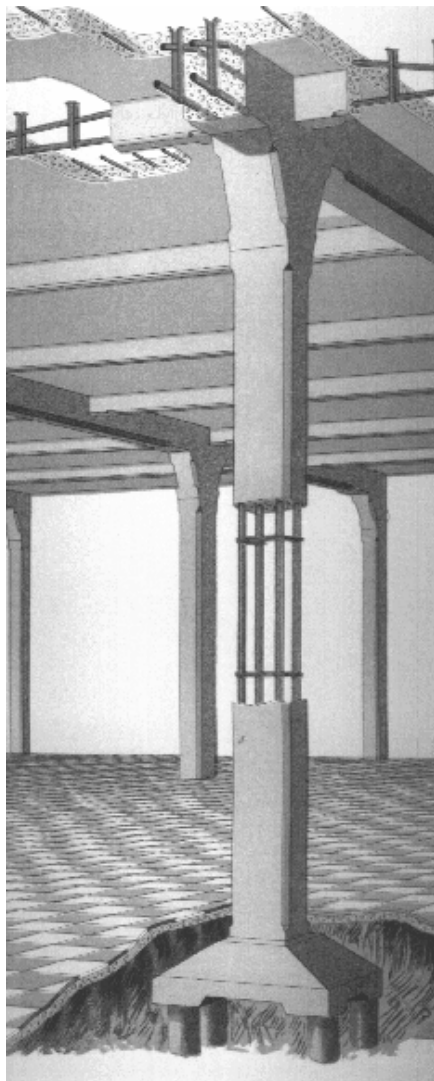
il sistema *Hennebique* permetteva la costruzione completa di un'ossatura portante monolitica in conglomerato cementizio armato che prevedeva plinti di fondazione (o travi rovesce o platee), pilastri, travi principali, travi secondarie e solette (da tesi di laurea di Casotto A., Sarain M., Stievano B., *Il recupero dell'area dell'ex macello di Padova*, laurea quinquennale in Architettura, Istituto Universitario di Architettura di Venezia, 1996, relatore Paganuzzi P.).
